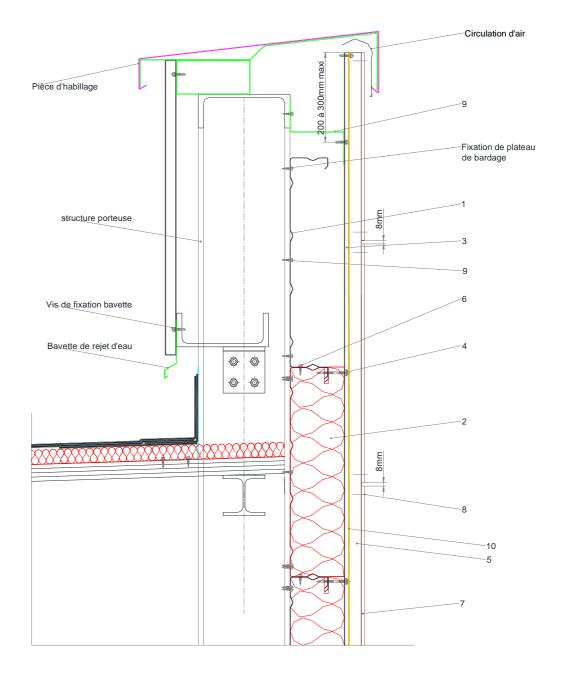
er – Arrêt sur acrotère – Coupe verticale
